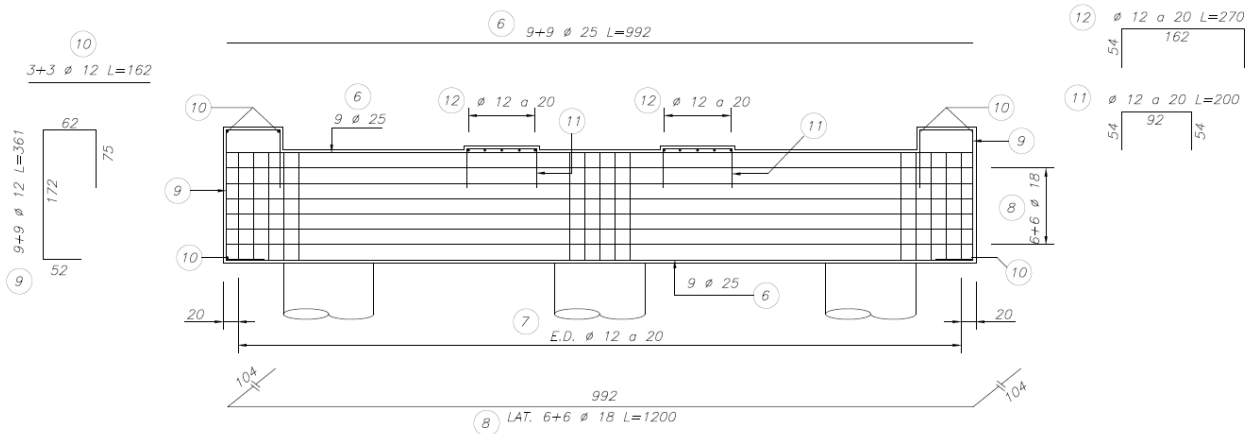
Disposición de Armaduras en Viga de Coronamiento Cepa.
